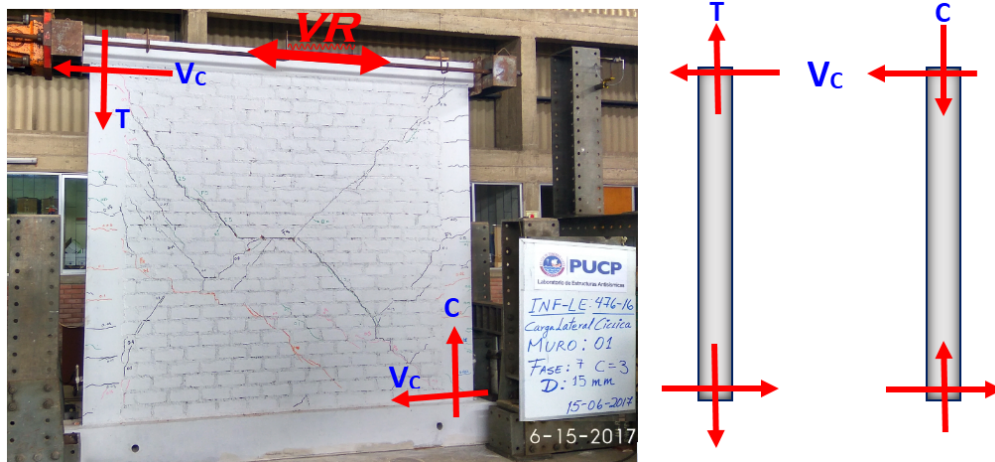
Equilibrio de fuerzas internas en muro agrietado.
